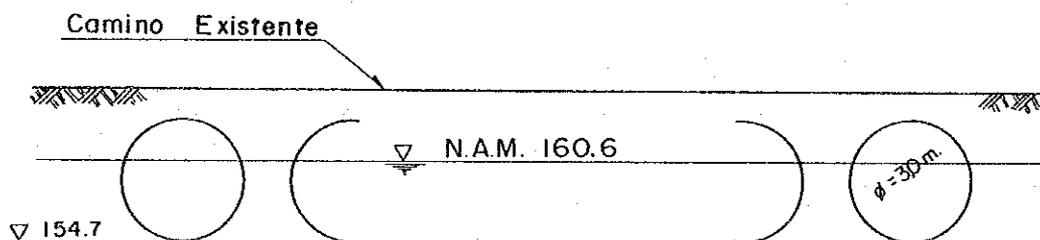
Alcantarillas de Chapas Corrugadas existentes en el sector Tigre.
